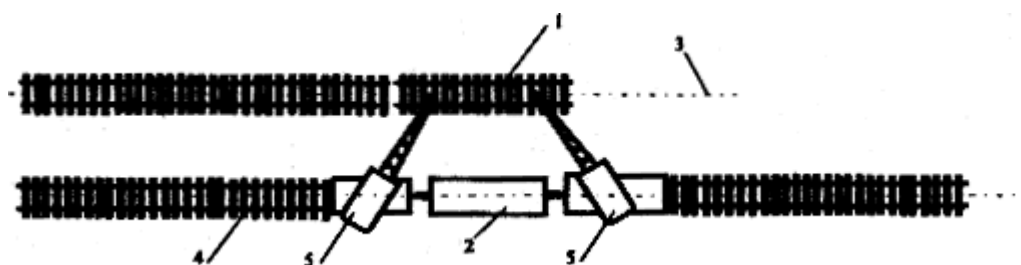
Укладка путевой решетки двумя железнодорожными кранами
